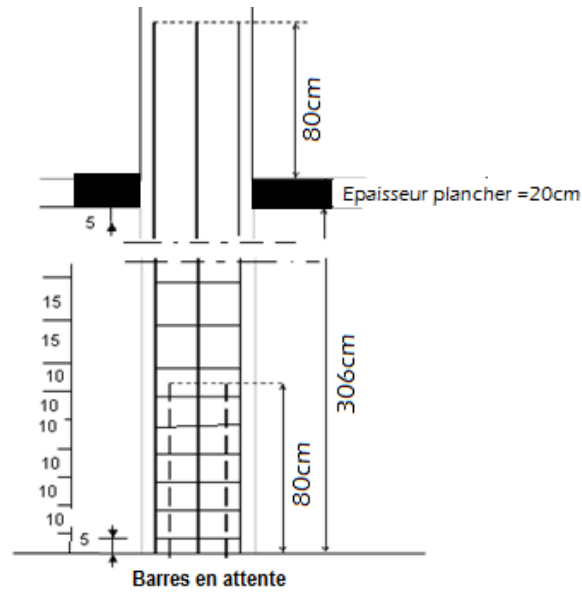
Schéma de ferrailage des poteaux des étages courants.
